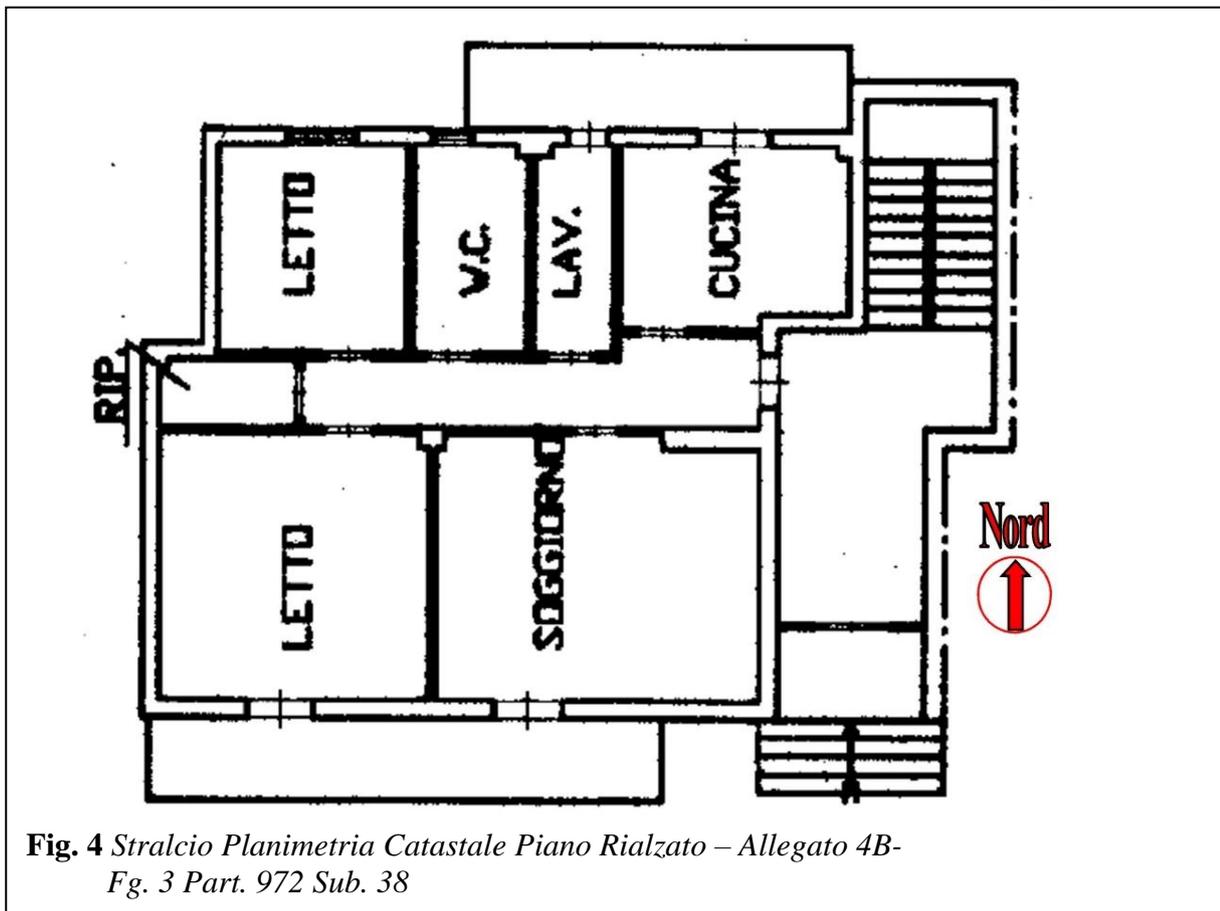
Stralcio Planimetria Catastale Piano Rialzato – Allegato 4B-
